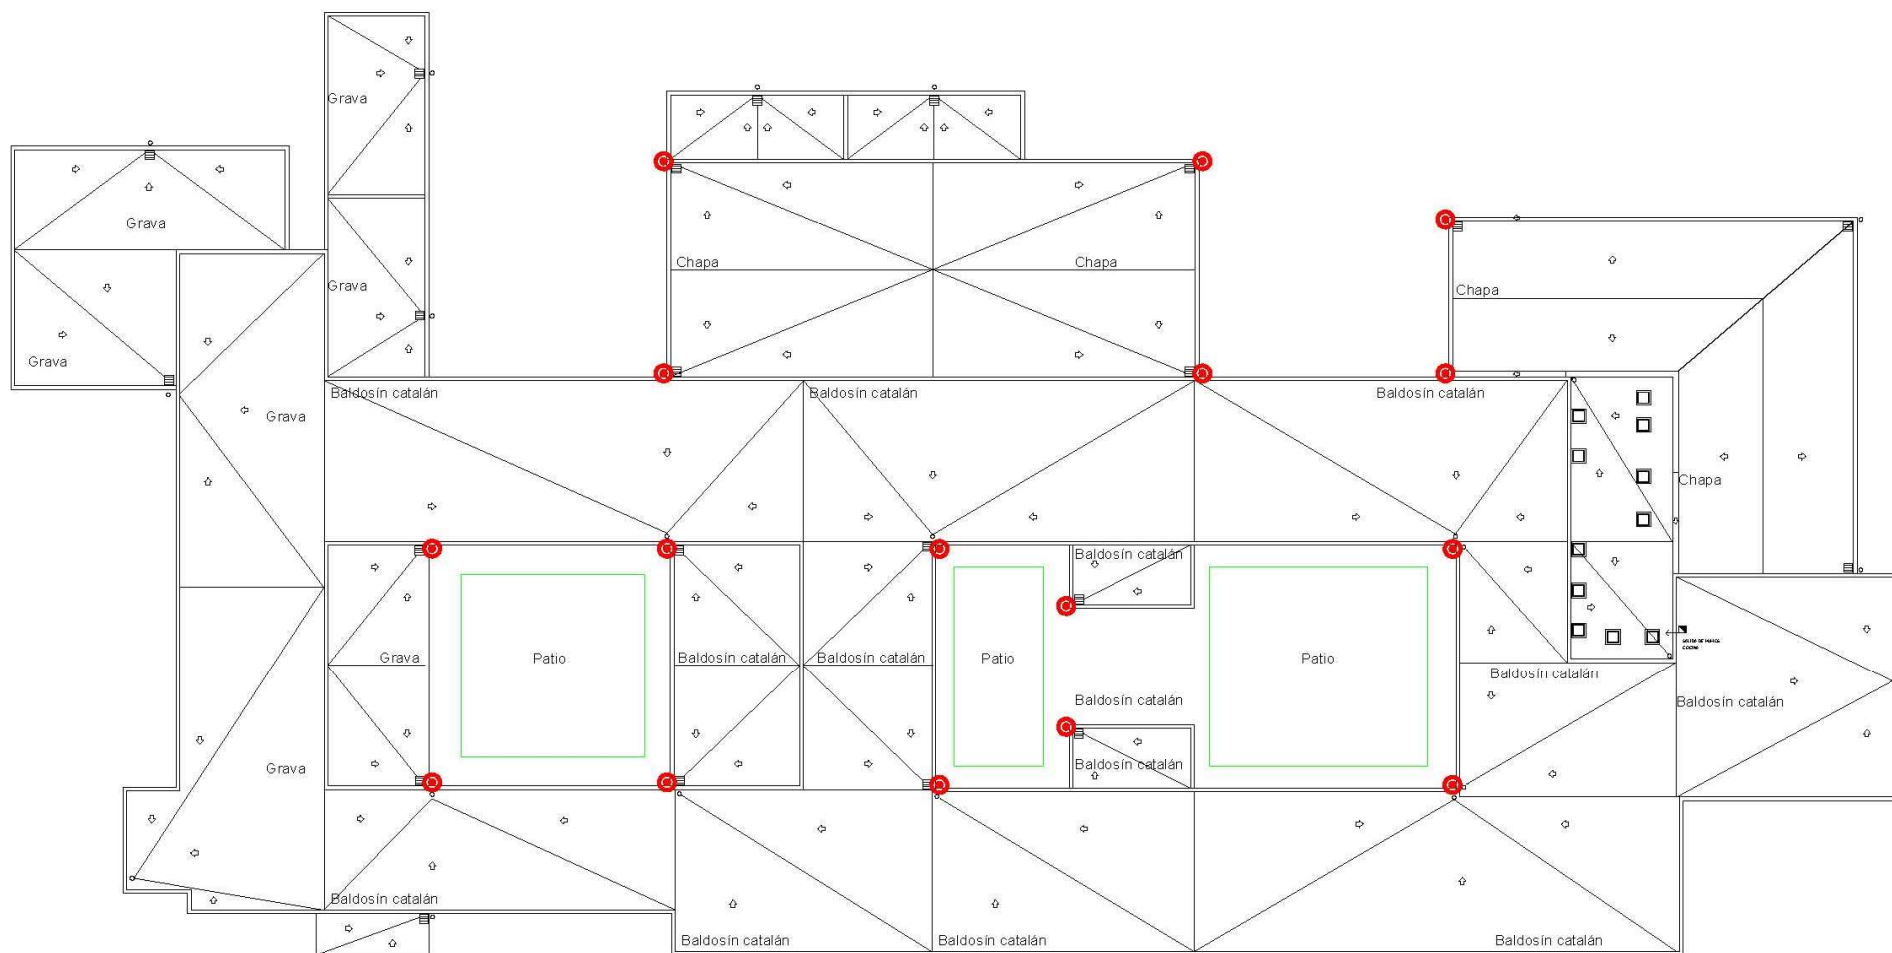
Plano de bajantes de pluviales en planta cubierta (Fuente Proyecto)
